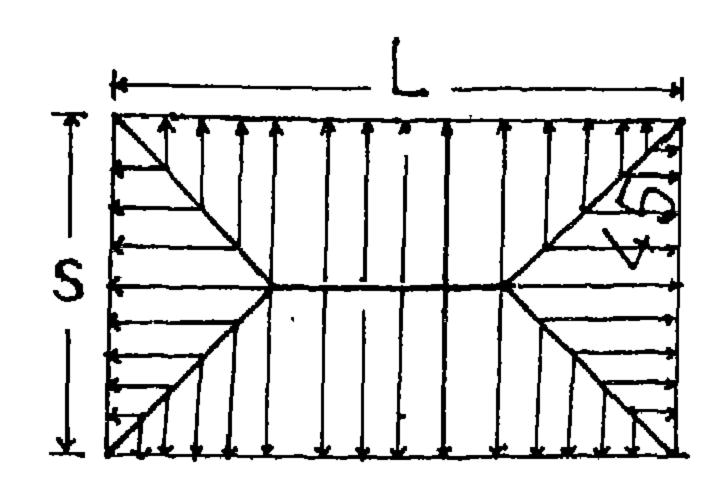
1) يوضح أنواع الأسقف (البلاطات) الخرسانية المسلحة
